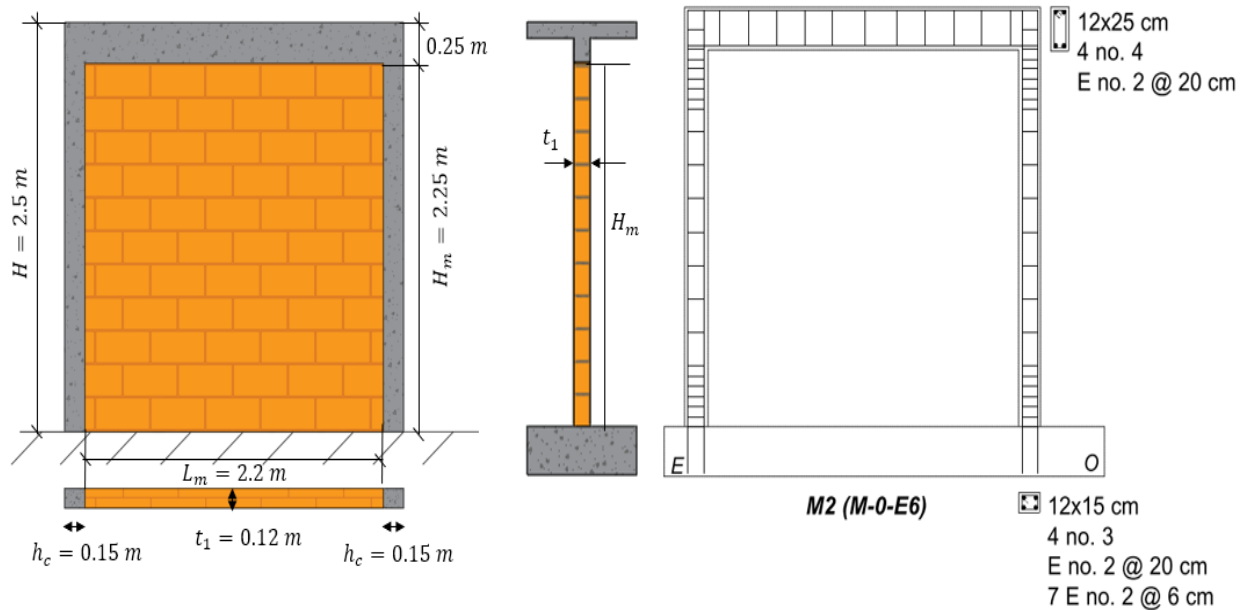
Geometría del muro M-0-E6 y detalle del refuerzo en los elementos de confinamiento
